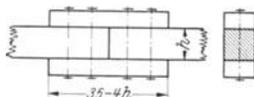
Stoß der Schwelle eines Lehrgerüsts.
